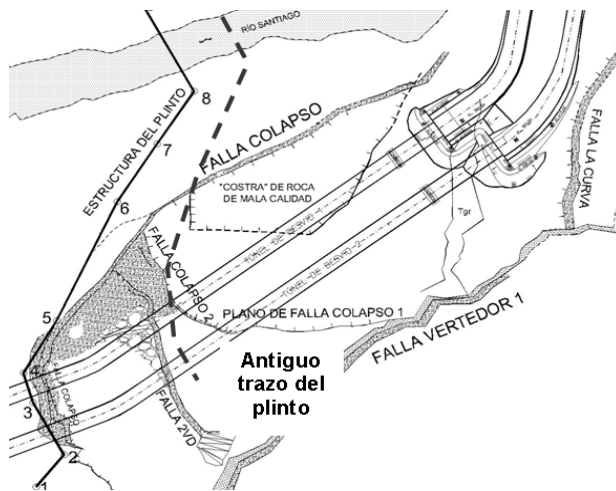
Planta con el plinto y su desplazamiento para salir de la zona inestable.
